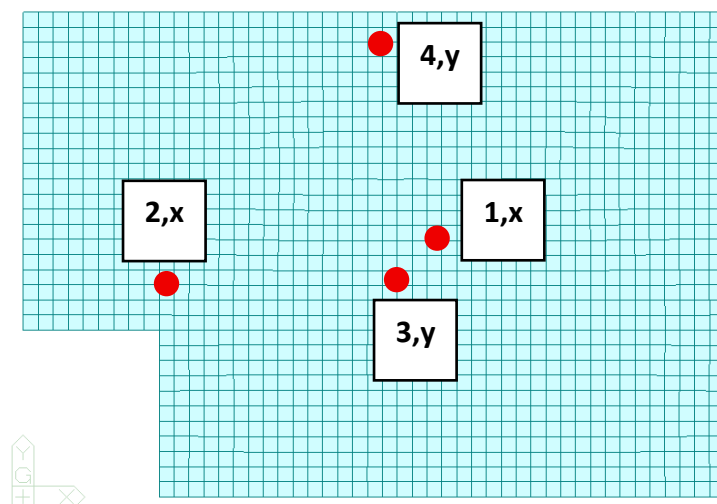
Pianta fondazioni, manufatto sfioratore.
